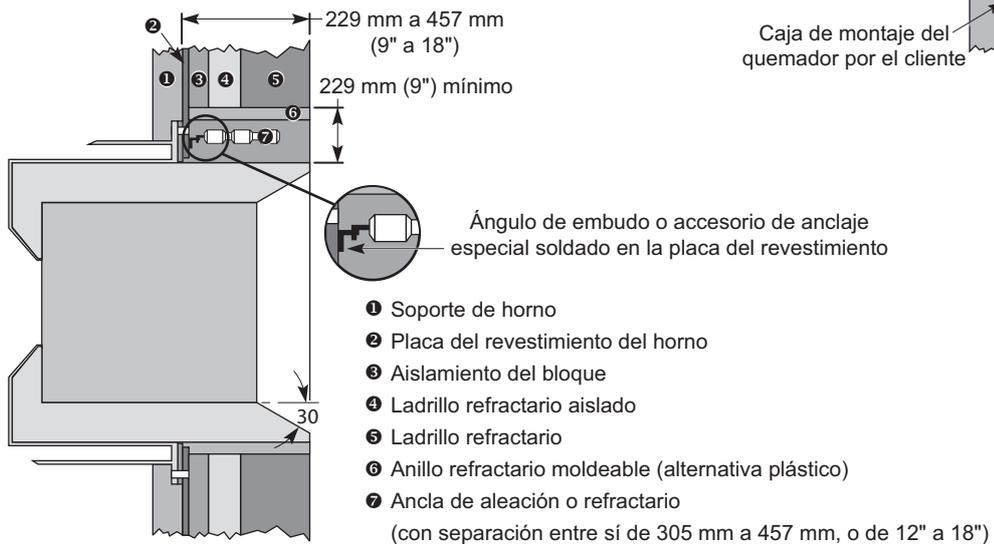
Disposiciones de montaje del quemador Vortometric
